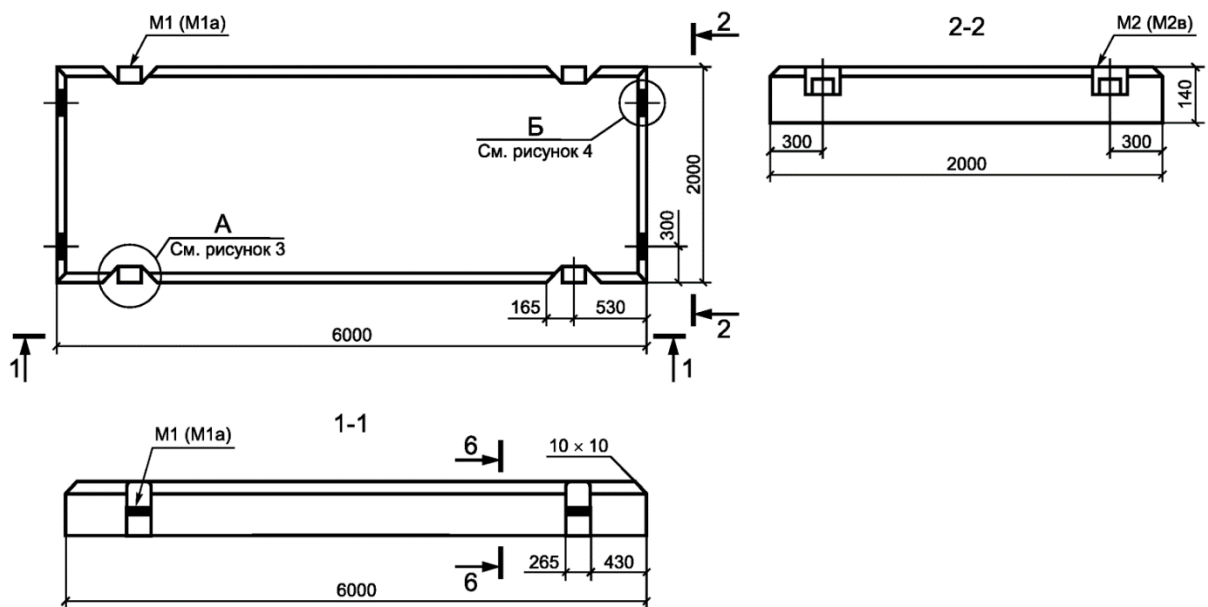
Внешний вид и основные размеры плиты ПАГ-14
